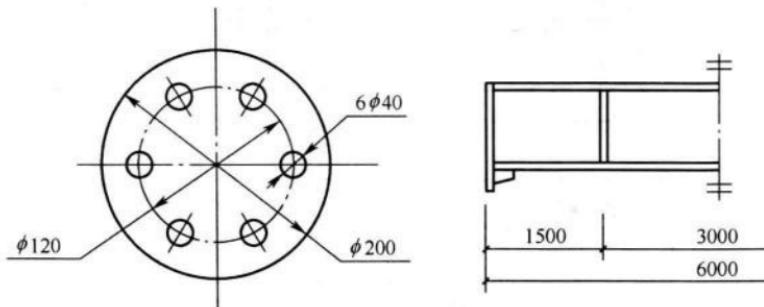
相同要素尺寸标注方法 图 1-11 对称构件尺寸标注方法
